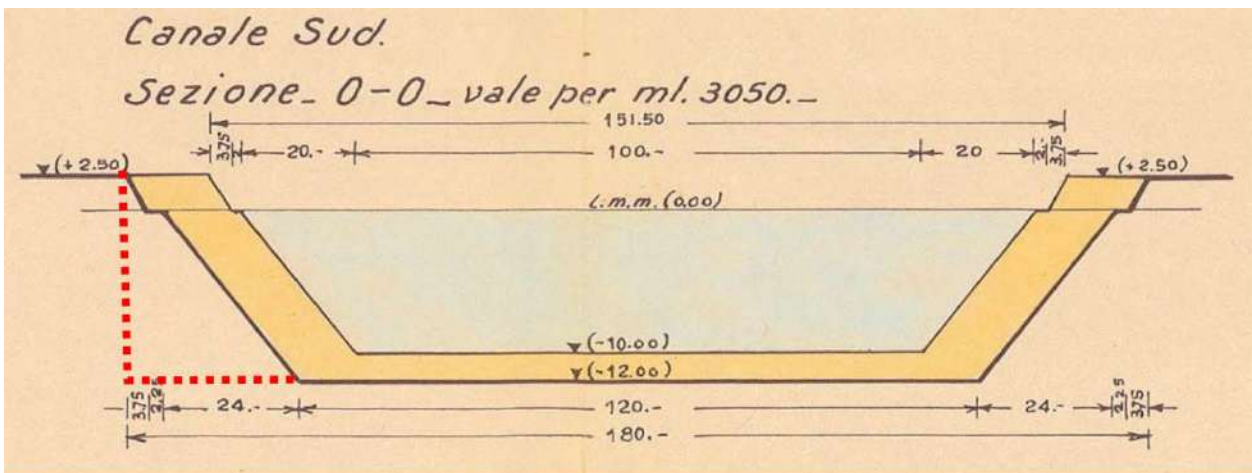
Estratto PRP 1965 – Sezione 0-0 con risagomatura cunetta di navigazione lato Sud filo banchina (in rosso tratteggiato la modifica)
